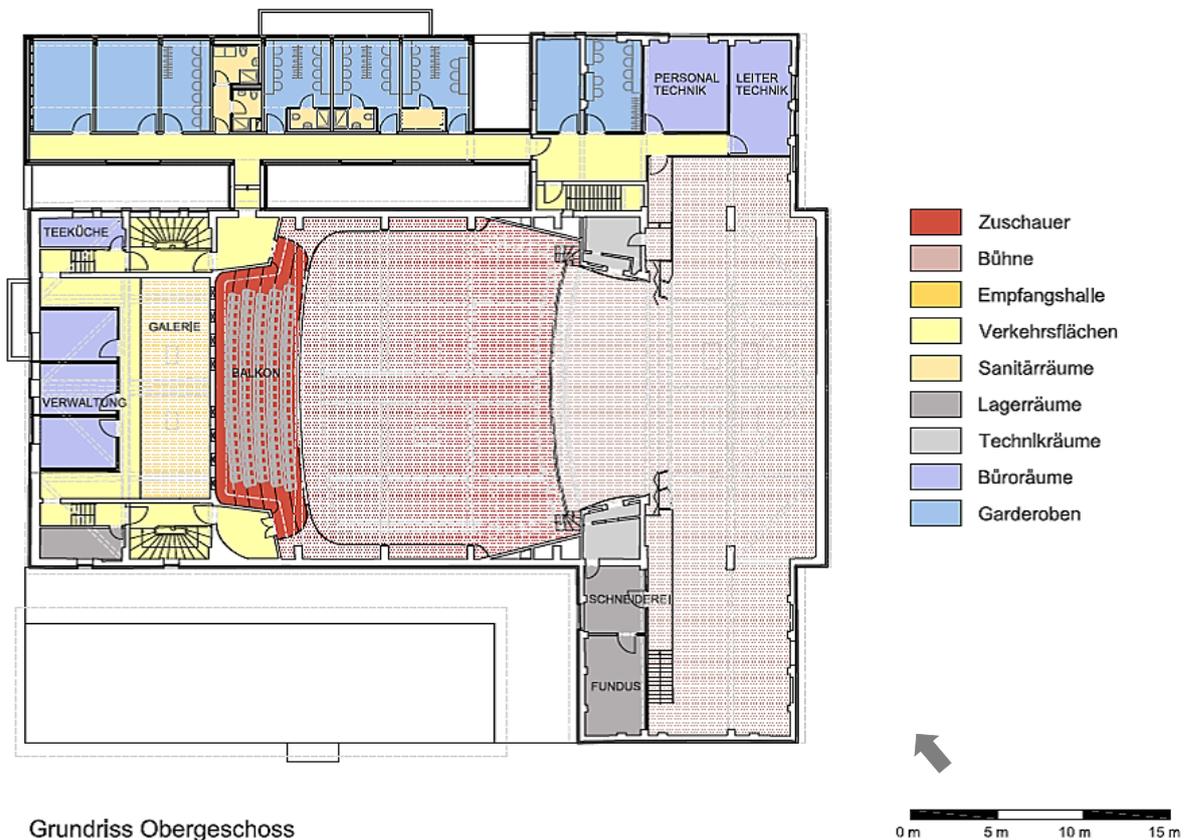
Grundriss Obergeschoss – „Umweltgerechte Bühne Wismar“
